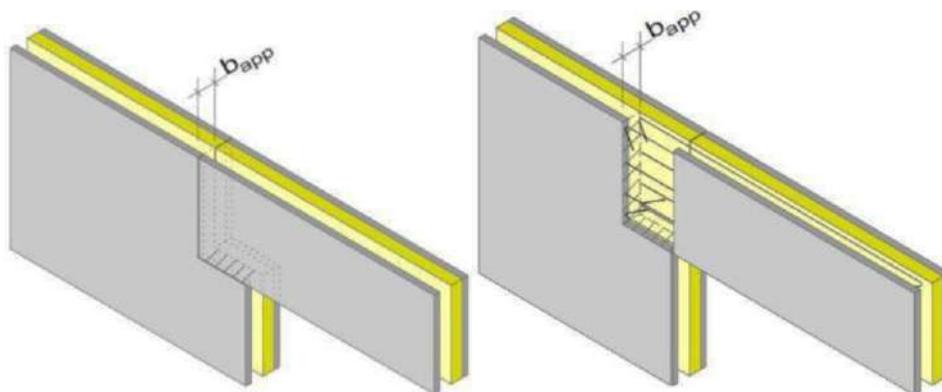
Appui de poutre – cas 1Figure 35– Appui de poutre – cas 2
